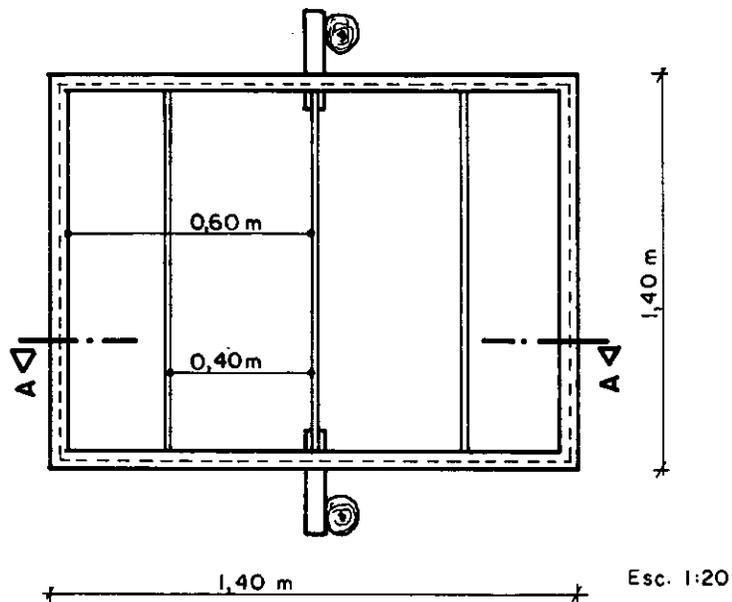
Planta baixa do saleiro automático-unidade (SA-1)
